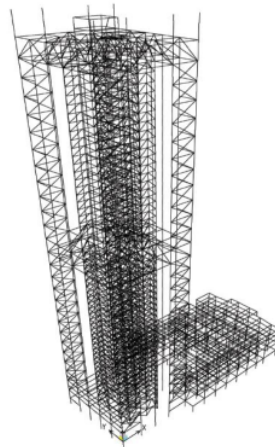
Sistema estructural del New York Times Building (Choi et al., 2012, p. 50)
